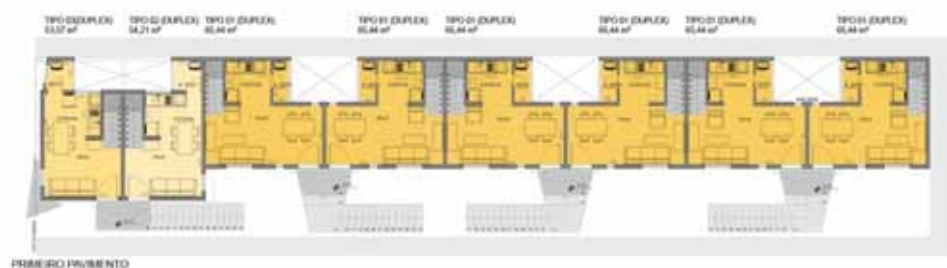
Primeiro Pavimento – Cohab Pedro Facchini
